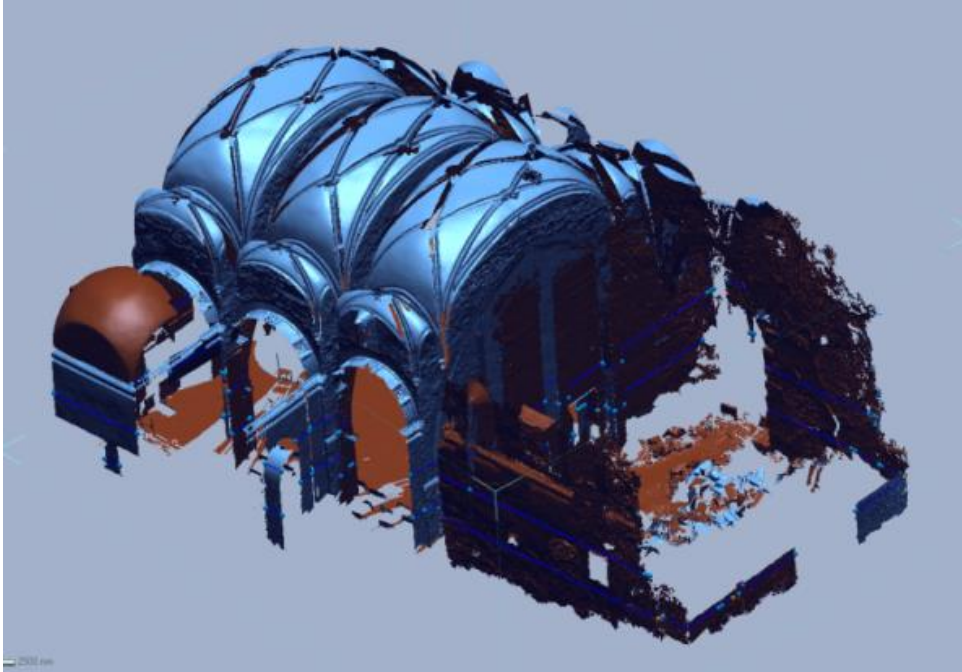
Imagen de las secciones horizontales para obtener la planta de la iglesia.
